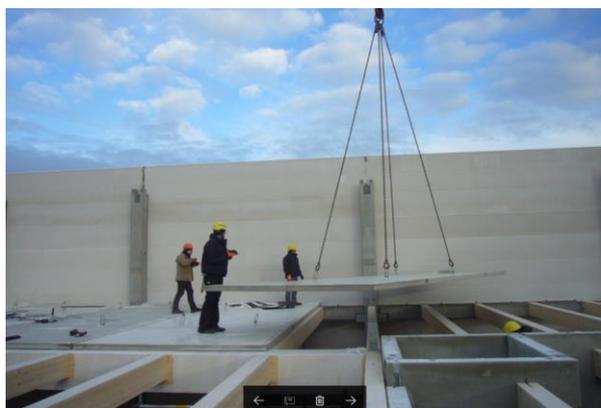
Verlegung von Betonfertigteilelementen (sichtbare Unterdecke mit integrierten FT-Verbindern auf einer Balkenlage)
